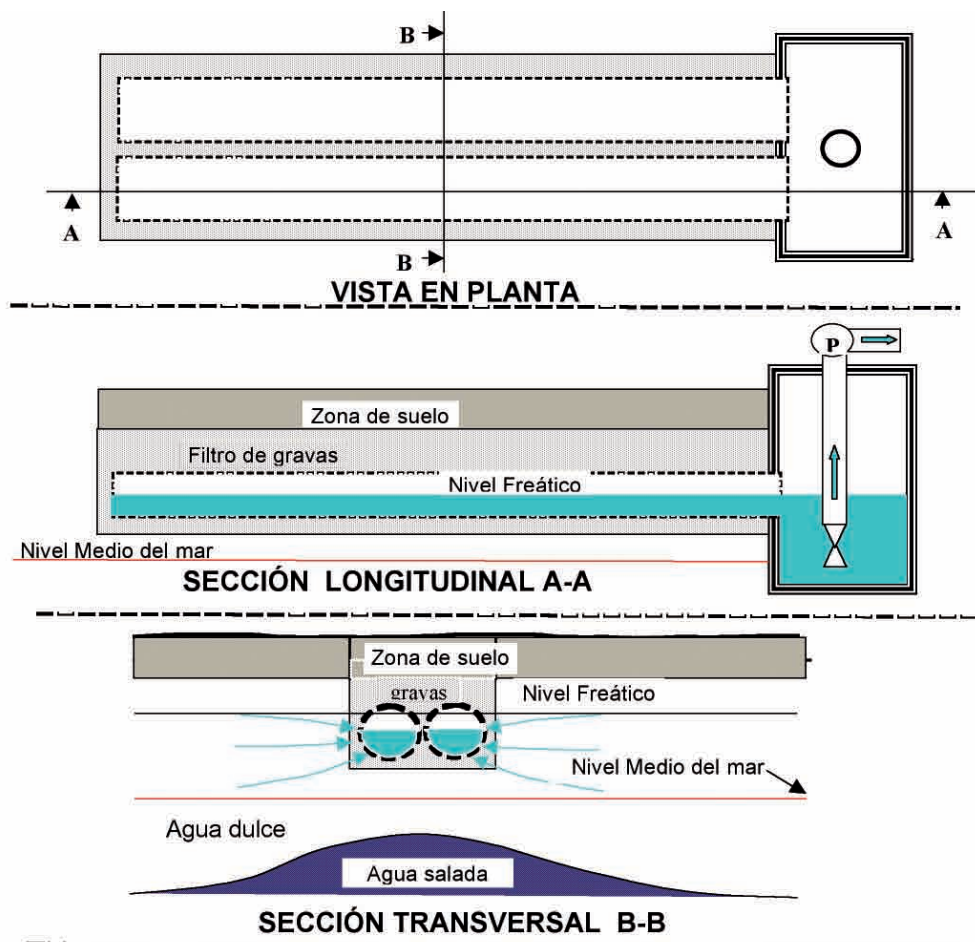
Esquema de colocación de drenes horizontales en trincheras abiertas
